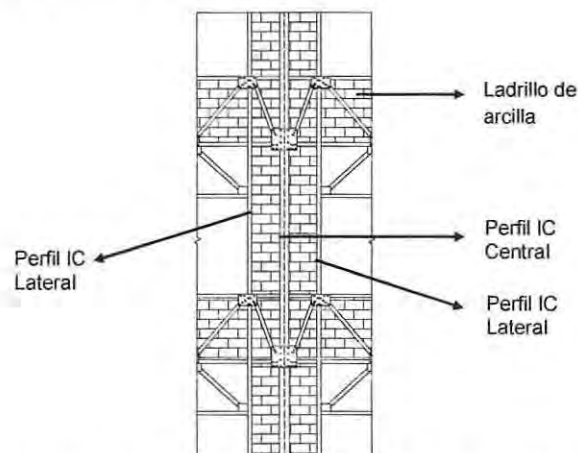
Pilar periférico tipo fachadas Norte, Este y Sur.
